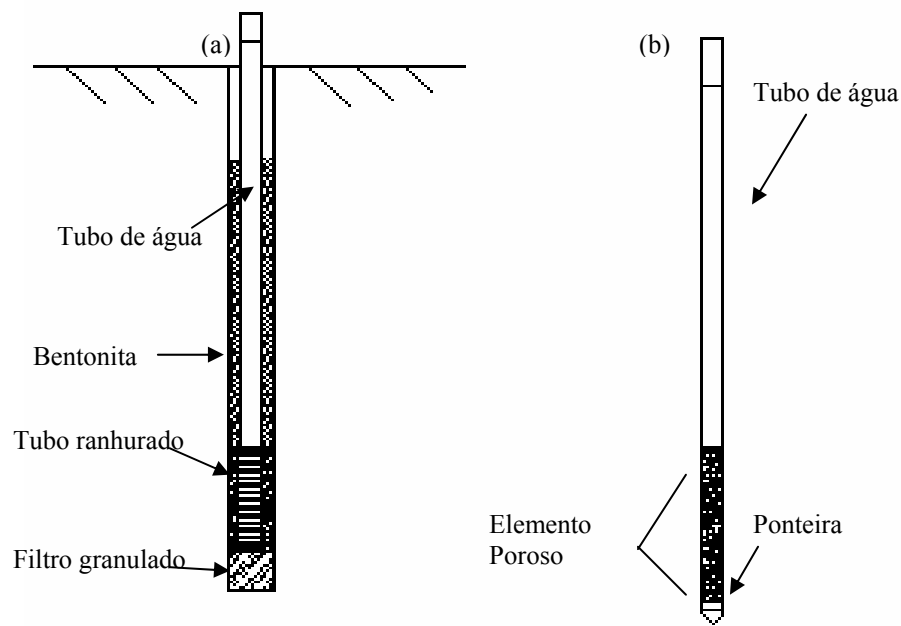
Piezômetro escavado (a) e piezômetro cravado (b)
